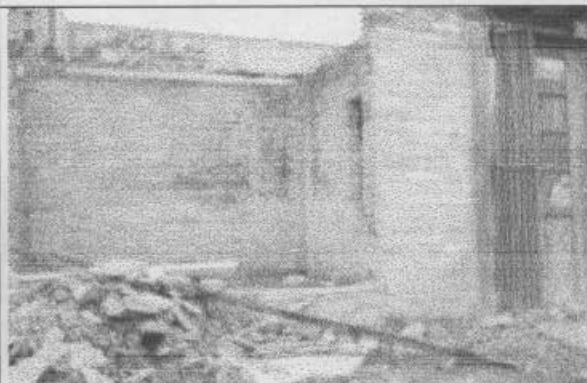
No se identificaron daños que comprometan la estabilidad de la estructura a corto plazo, sin embargo es evidente el estado de abandono y deterioro al interior de la construcción.
